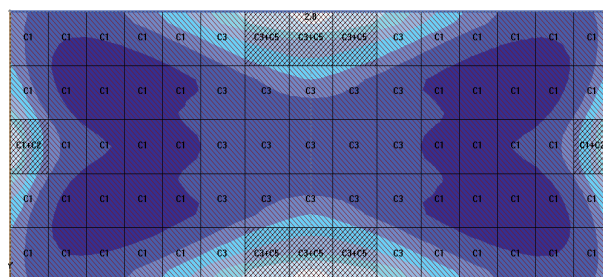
Схема раскладки арматурных сеток нижнего пояса
